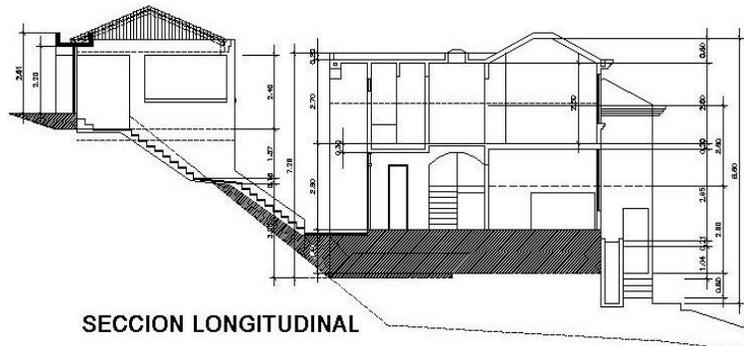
SECCIÓN DEL PROYECTO. FUENTE: Proyecto de Construcción Vivienda Familiar, señor Mauricio Catalán.
